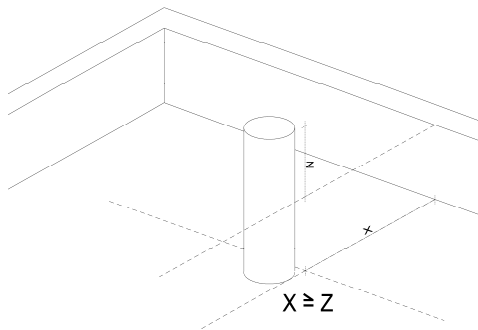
Beispielskizze Mindestabstand der Dachaufbauten zu Außenfassaden
